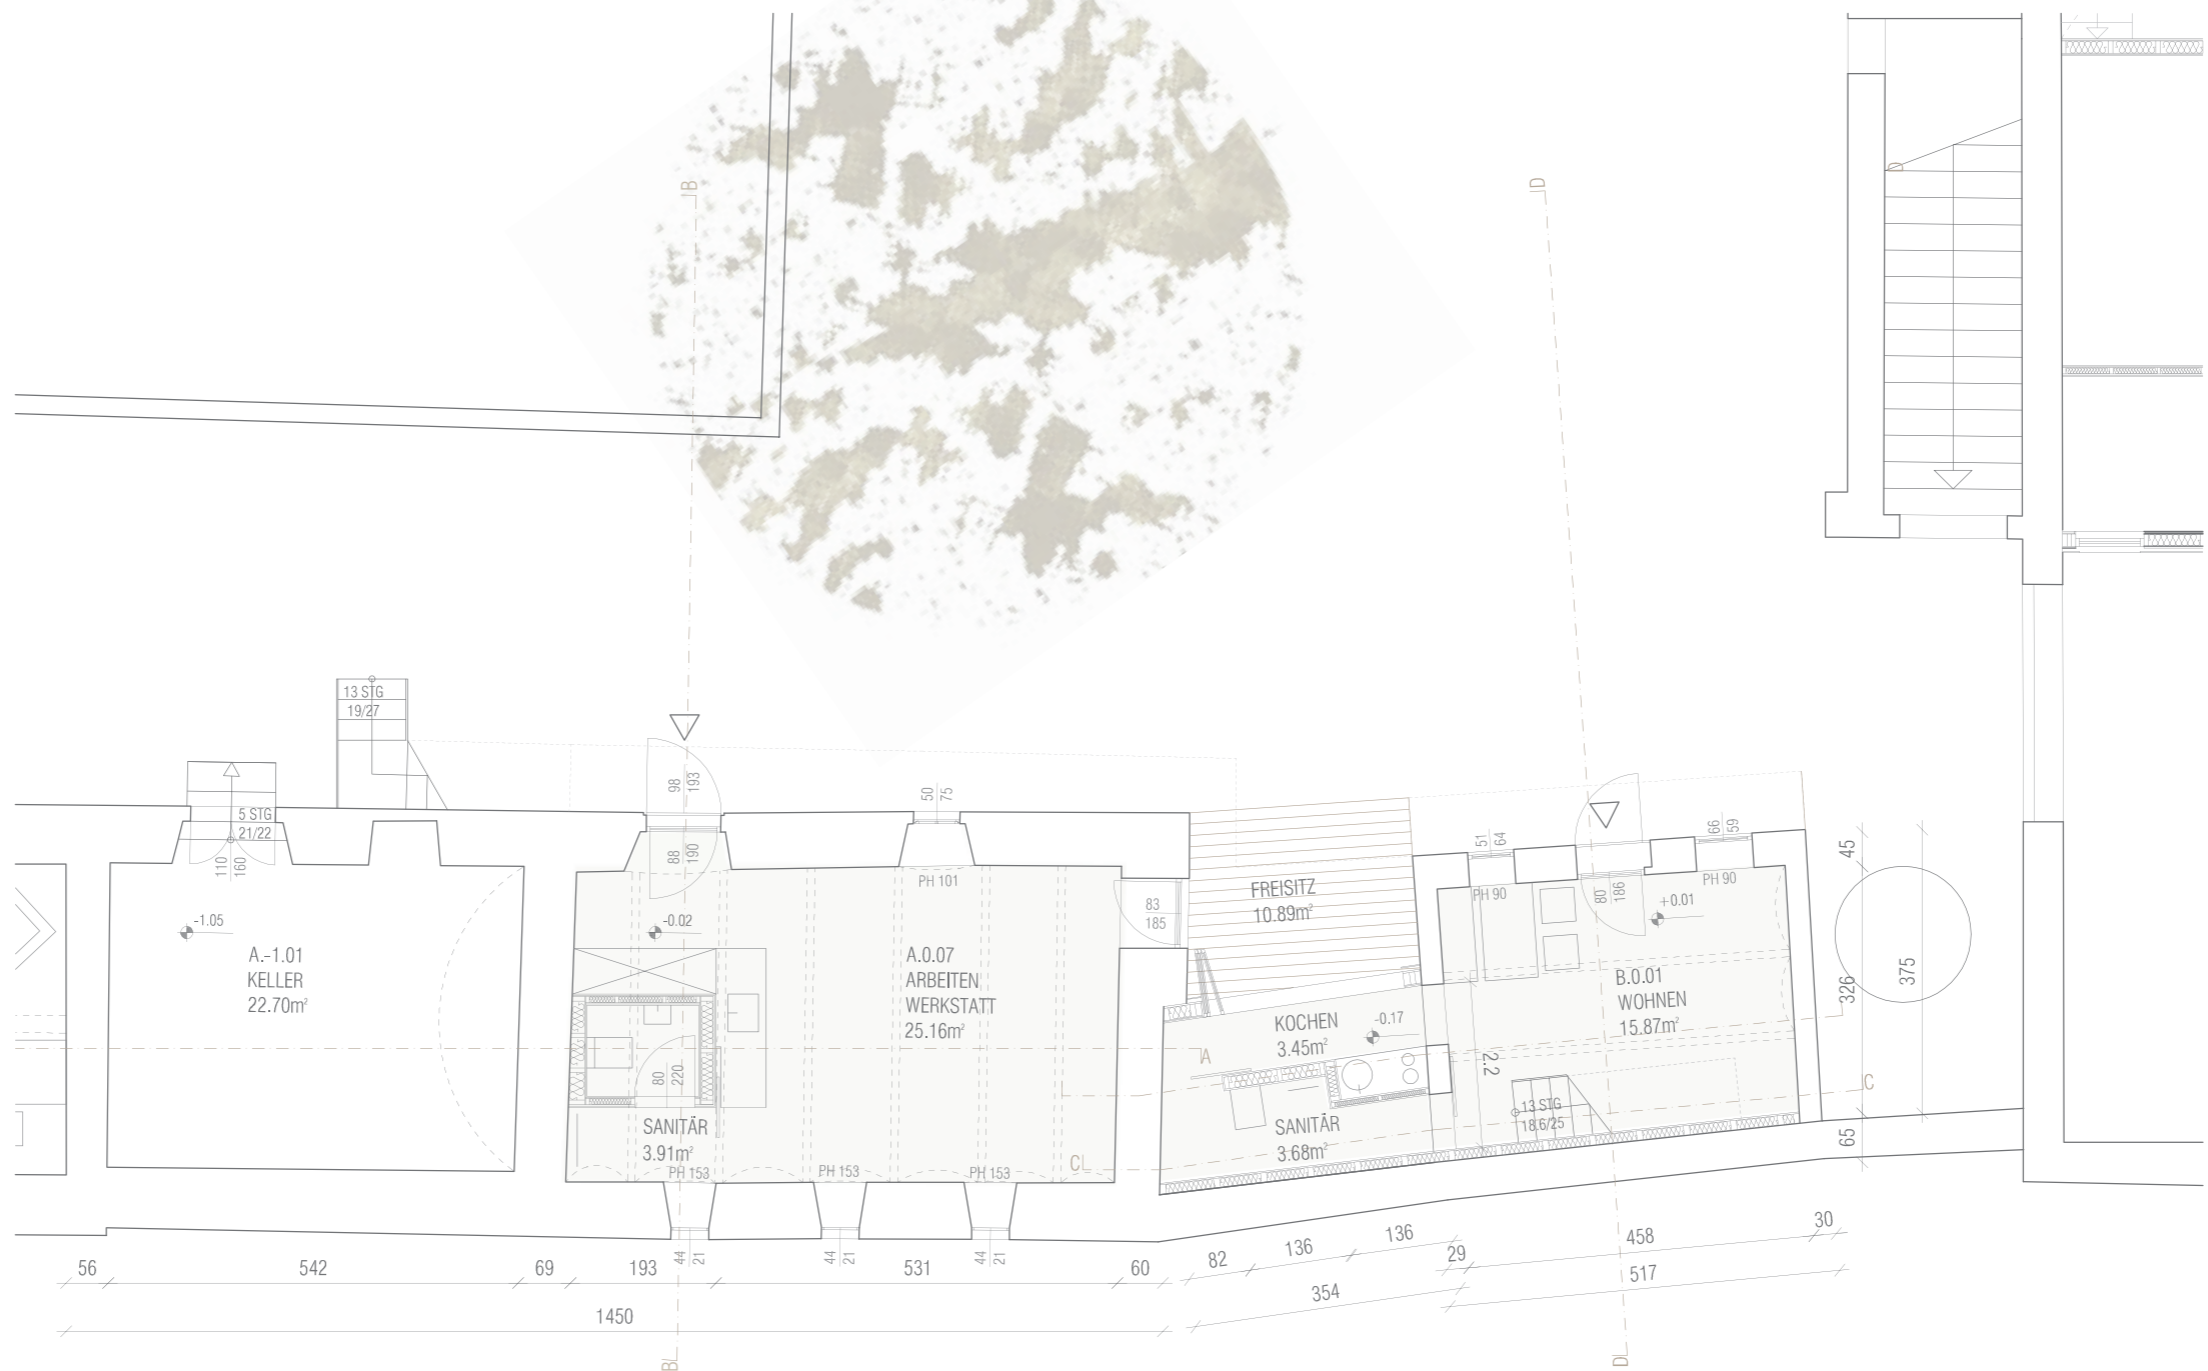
Gebäude A_WOCHENENDHAUS_Gebäude B_GÄSTEHAUS_Grundriss Erdgeschoss Maßstab 1:100
